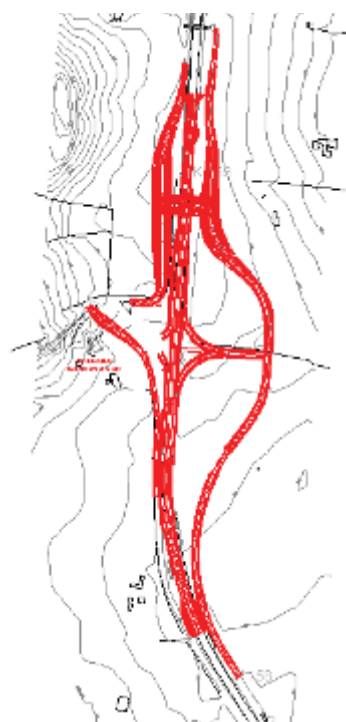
Planimetria stato di progetto presso lo svincolo di Bonorva sud al km 158
